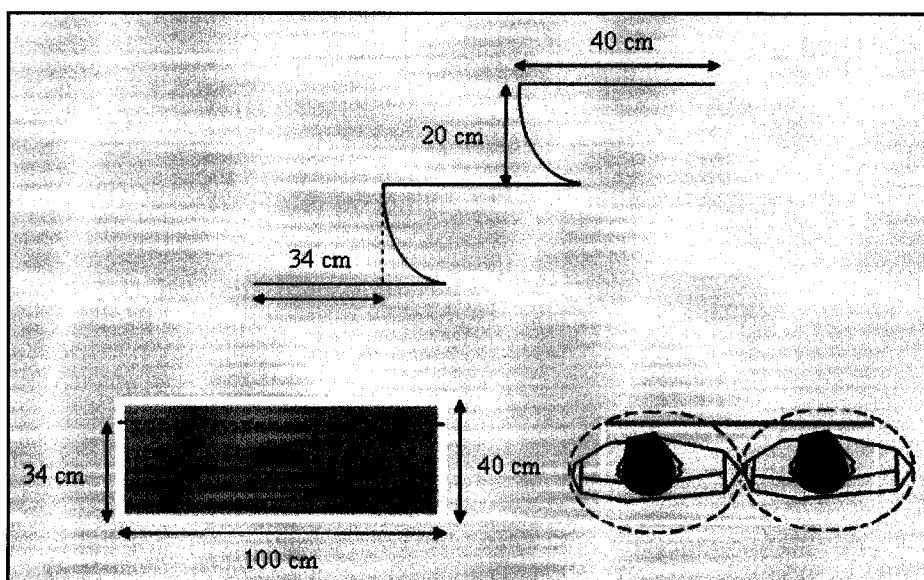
Dimensions des marches d'un escalier mécanique (Vue de profil et vue en plan, inspirée et image tirée de ³⁹)
